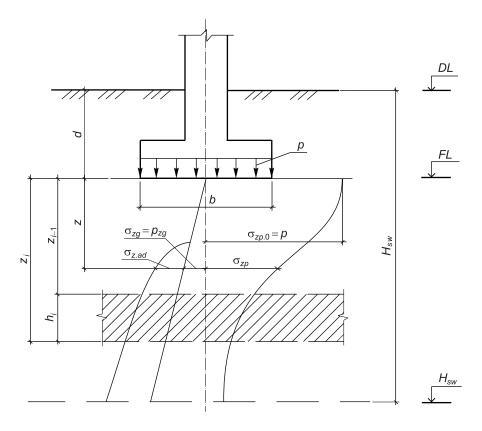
Схема к расчету подъема основания при набухании грунта
